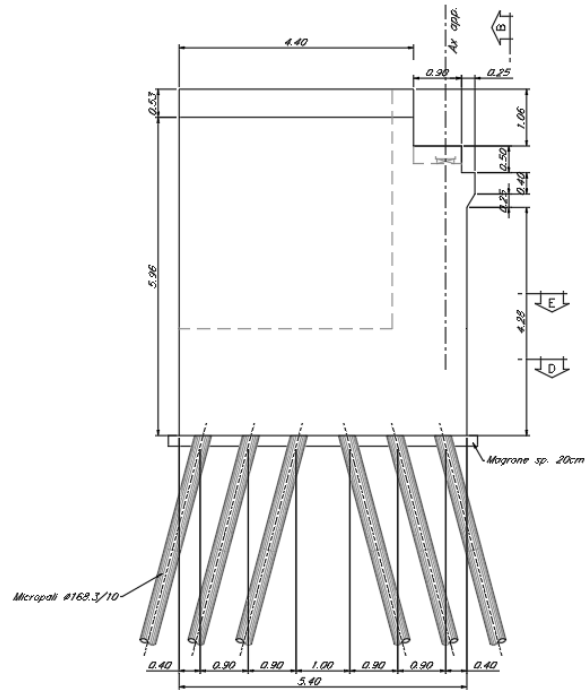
Prospetto Longitudinale Spalla A
